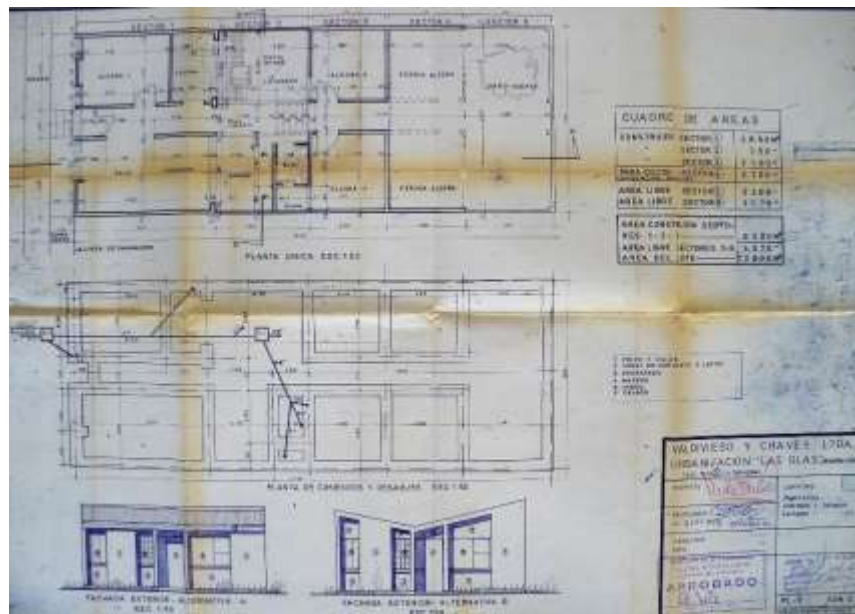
Proyecto barrio La Olas, Plantas y alzados, Aprobado en Bucaramanga, 1966. Figura 212. Proyecto barrio Las Olas, Cortes, cubierta y localización, Bucaramanga, 1966. Fuente. Archivo, Planeación Municipal.
